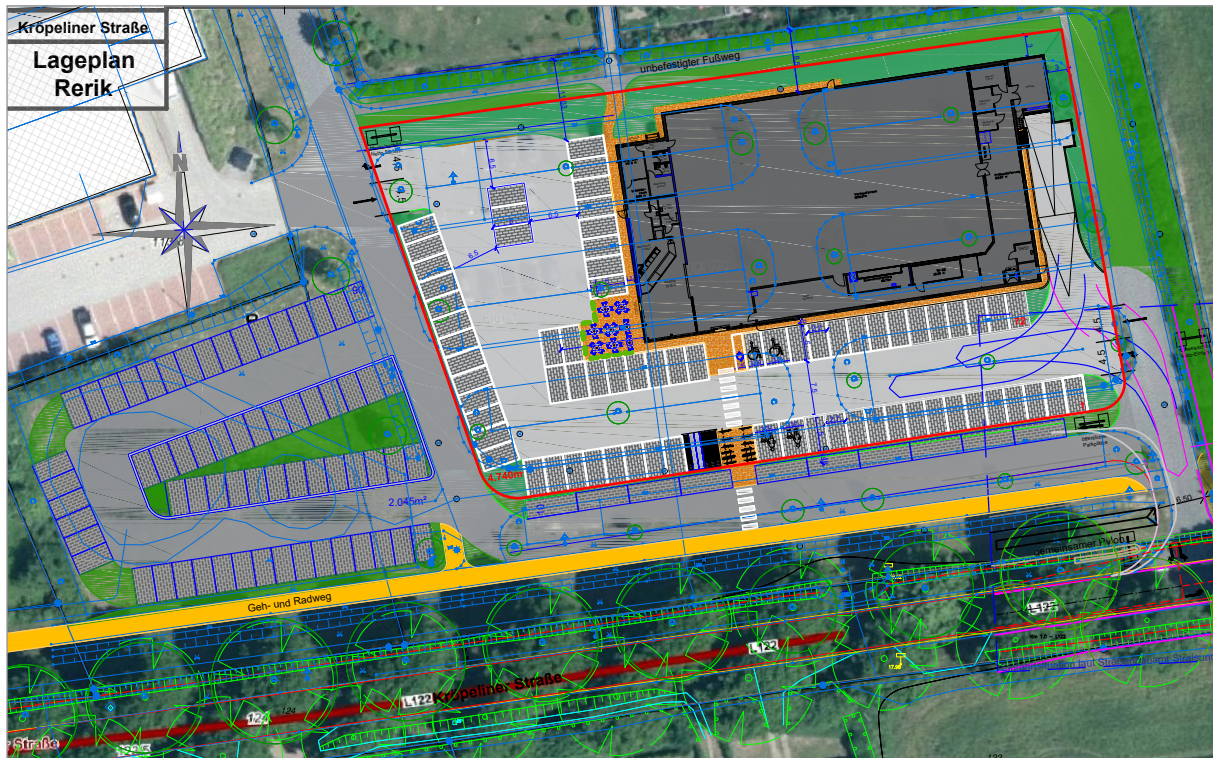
Lageplan der Herget Projekt- & Grundbesitzgesellschaft mbH & Co. KG B
